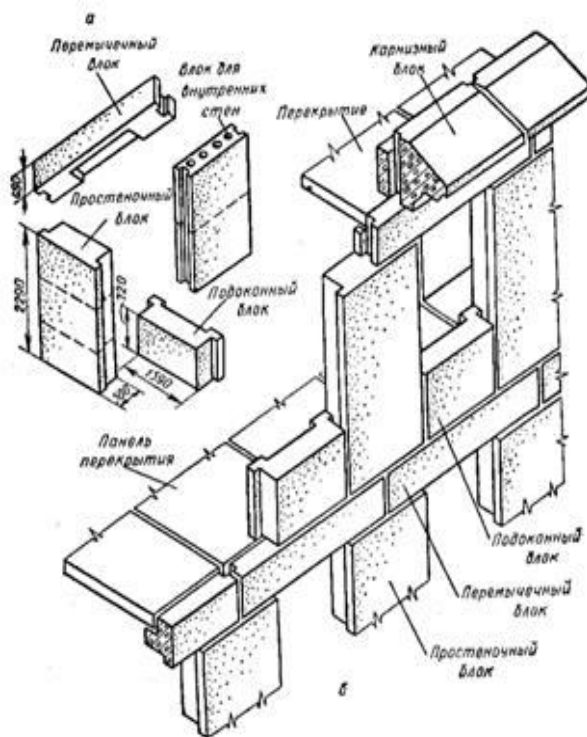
Схема сборки стен зданий из крупных железобетонных блоков:
